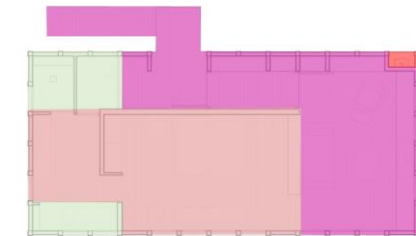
| Fonte: ARCHDAILY, 2015b. EDIÇÃO AUTORA.
